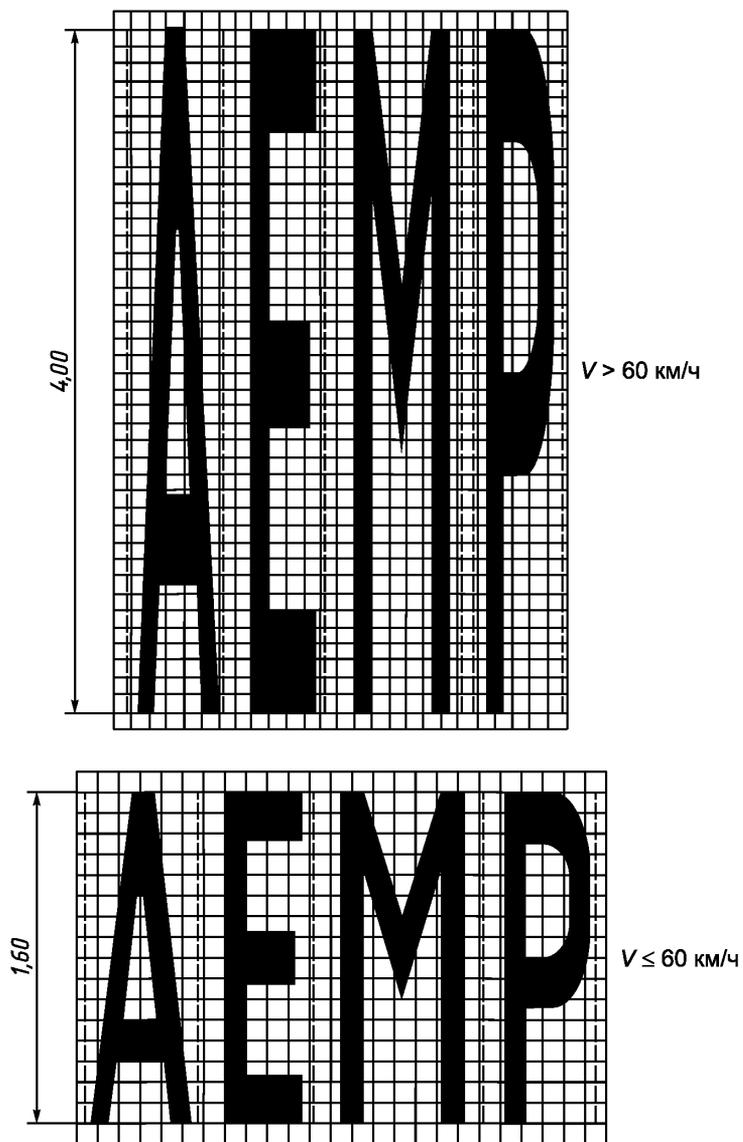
Форма, расположение и размеры букв разметки типа 1.22
